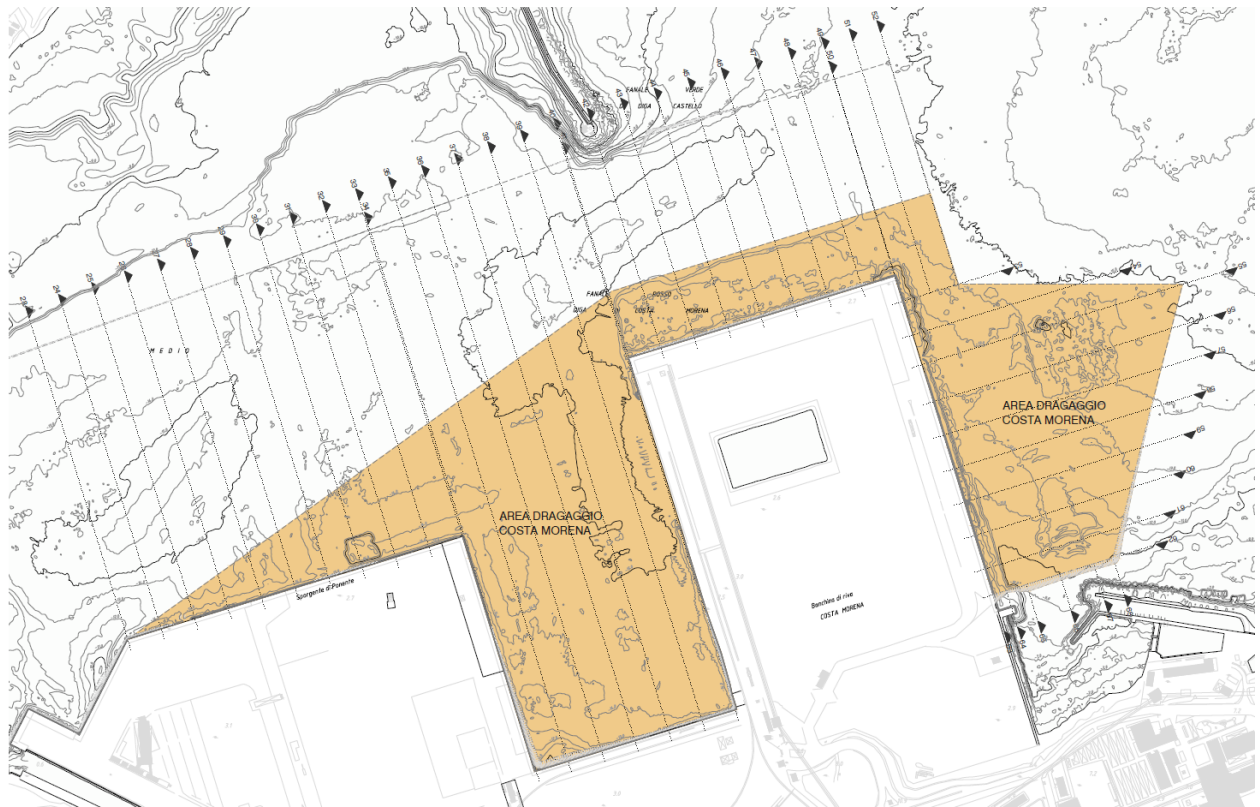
Planimetria di dragaggio Area Costa Morena
